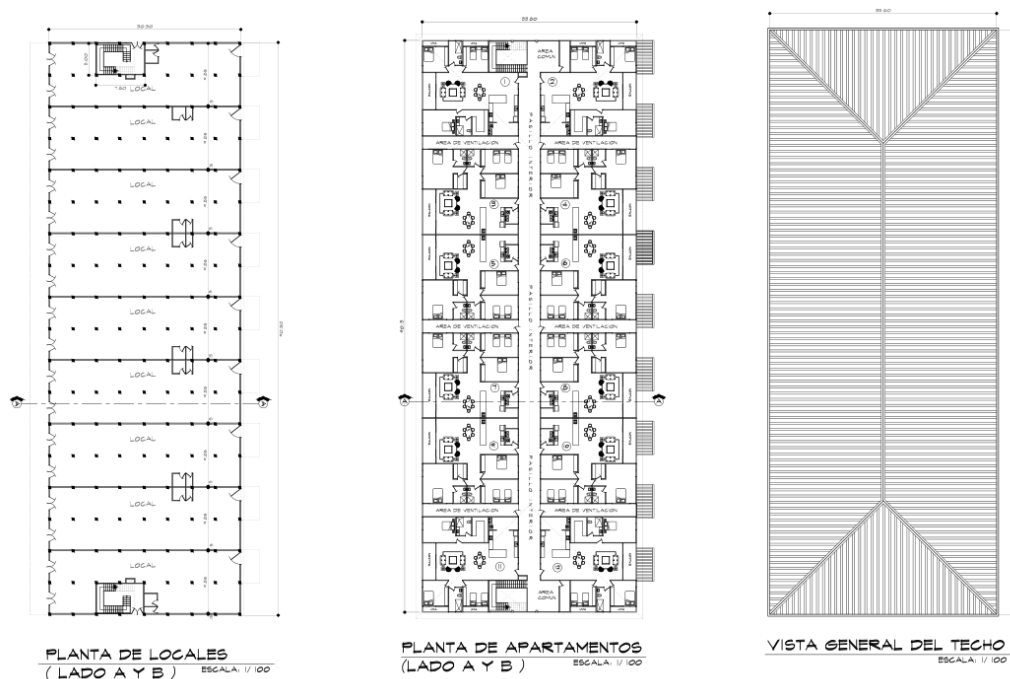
Planta de Locales y Apartamentos (Lado A y B) y vista general del techo
